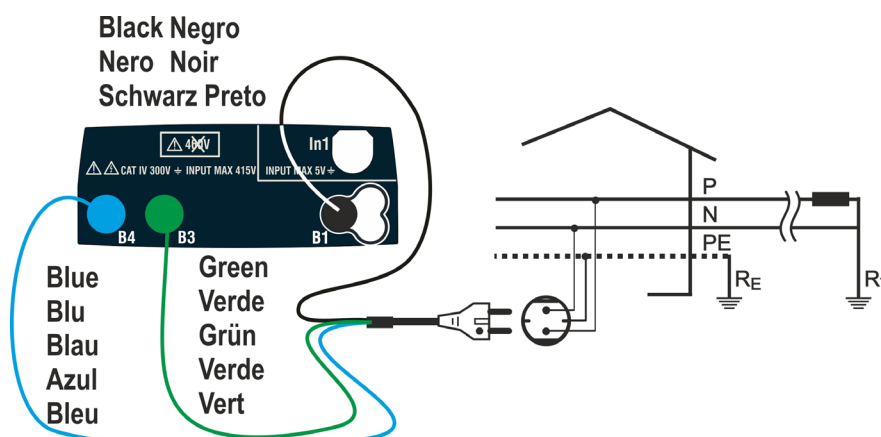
P-N/P-PE Test für 230V ein-/zweiphasige Systeme mit Schuko-Stecker
